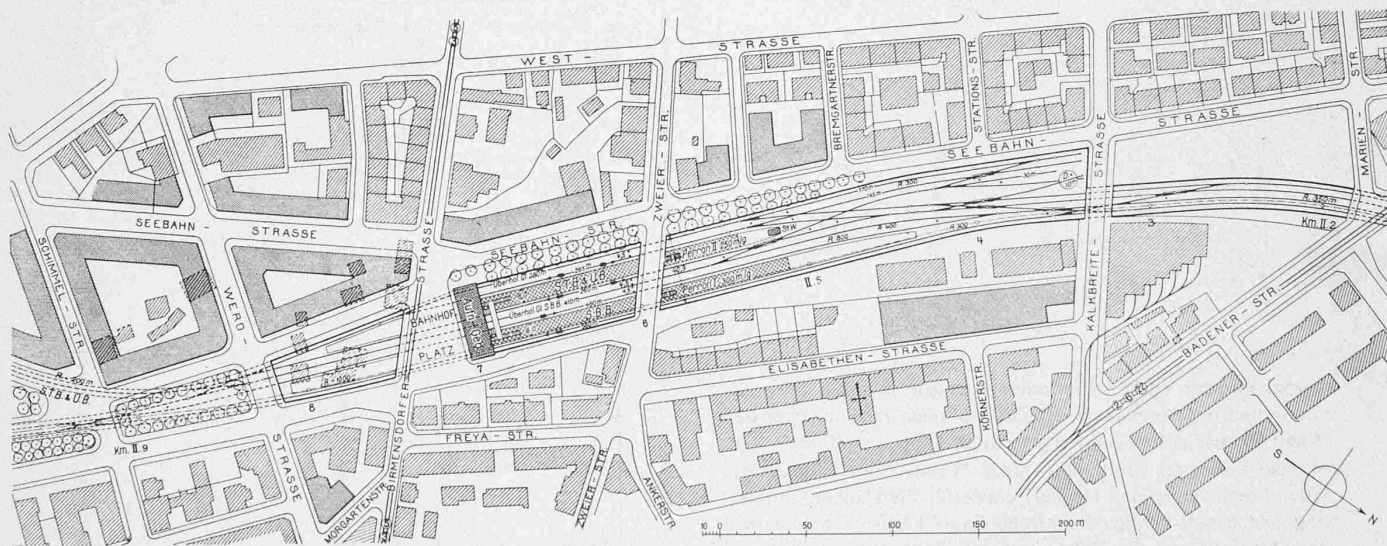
Lageplan des neuen Bahnhofes Wiedikon an der Strassenbahn nach Hottingen und Fluntern. — Masstab 1:4000.
